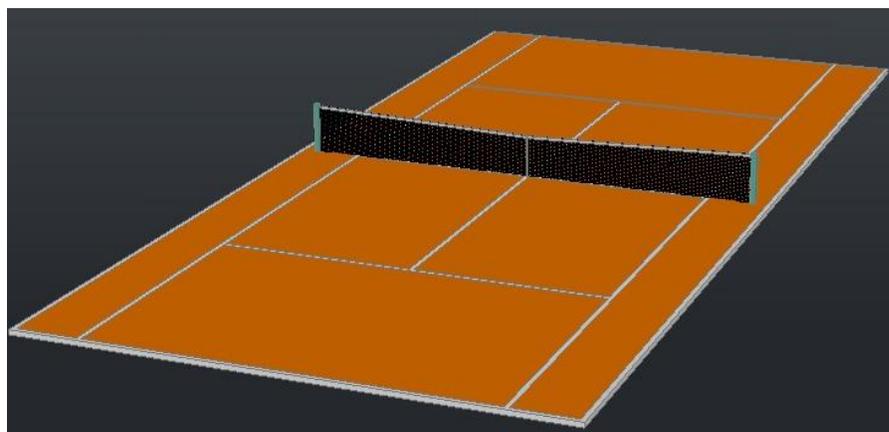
Cancha de Tenis (Planos de Casas – Planos de Construcción , 2012)
